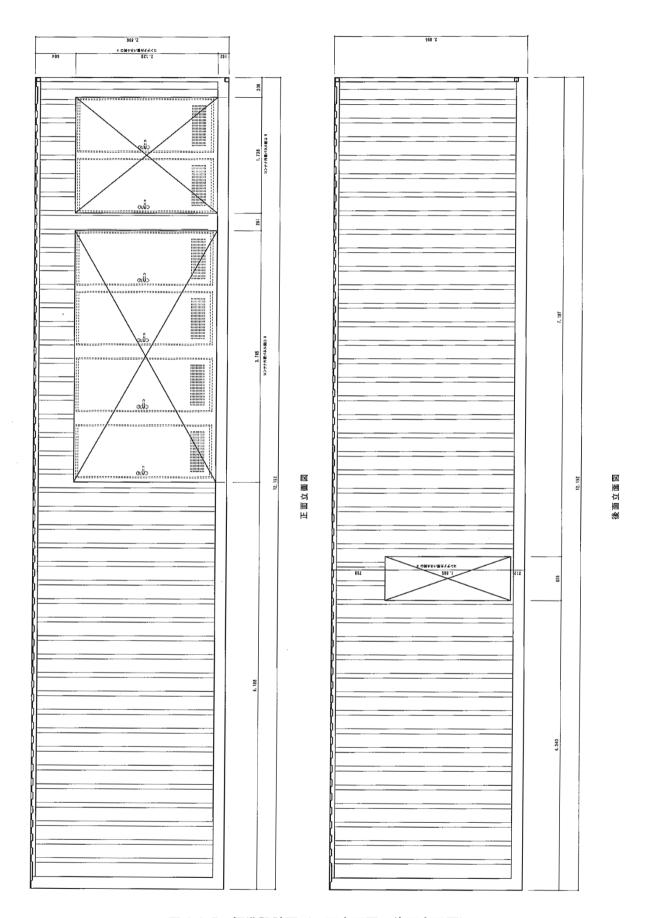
標準設計図 (正面立面図・後面立面図)
